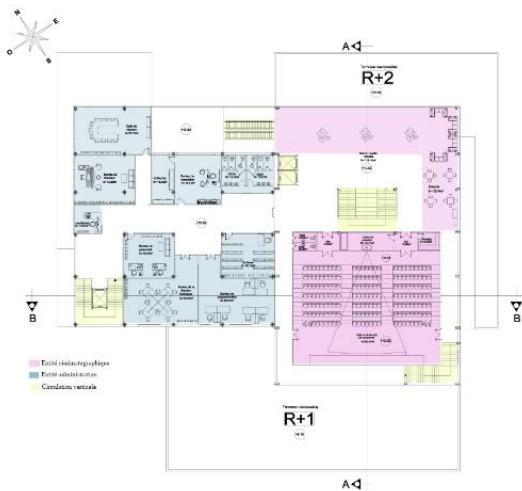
Plan 3^{ème} étage, (source : auteur).
